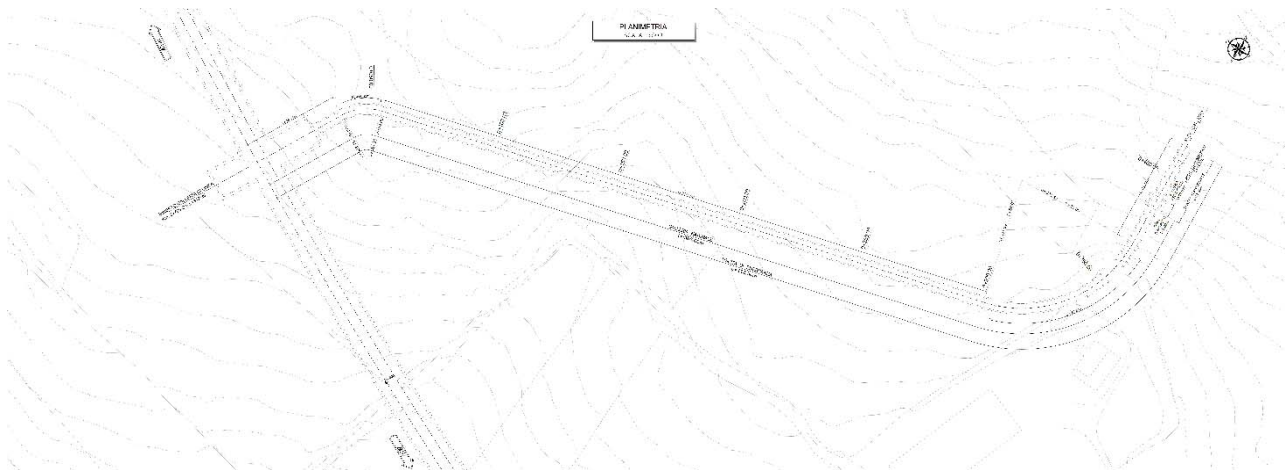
Planimetria della uscita/accesso di emergenza sulla Galleria Grottaminarda
